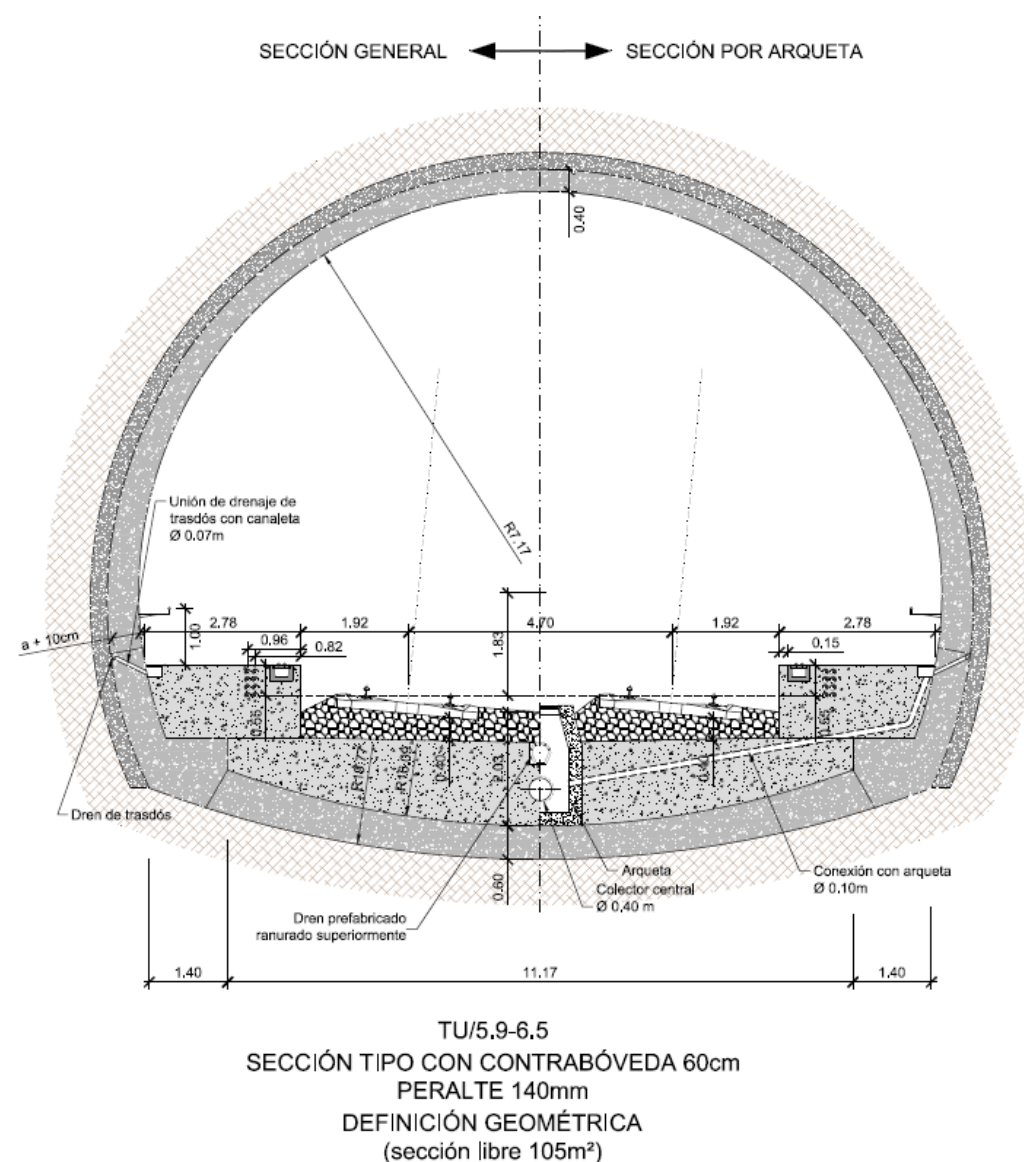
Sección tipo túnel de Ameyugo I. Fuente: Proyecto constructivo 2013
